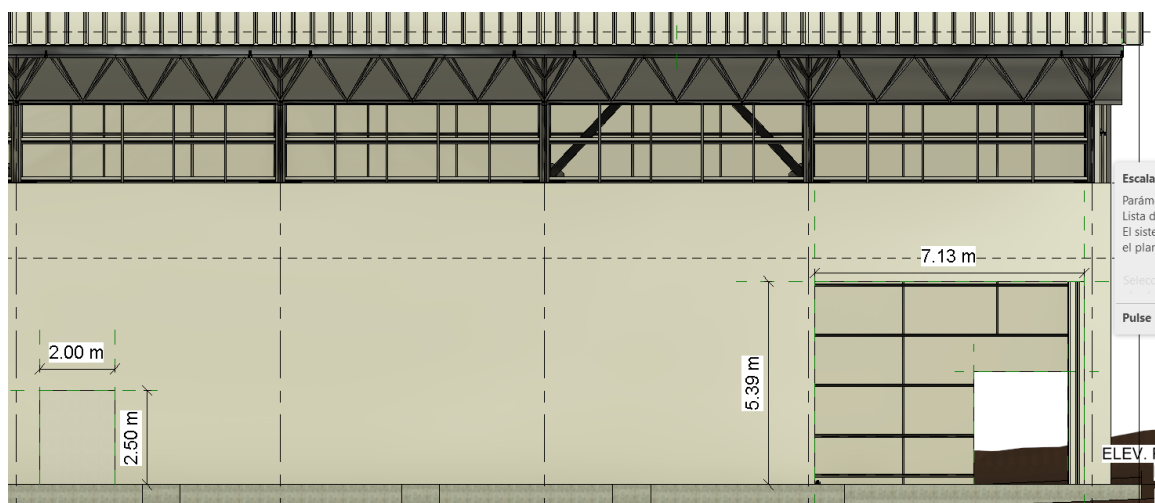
Acceso principal y acceso caseta de ventilación (elaboración propia).
